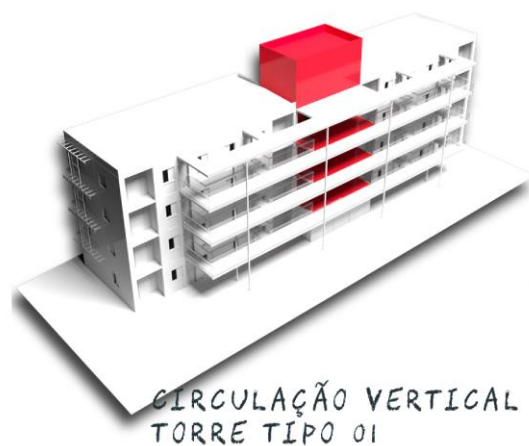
Circulação horizontal e vertical na torre tipo 01.
